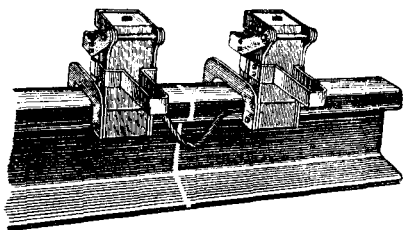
Стыковые соединители приварные (термитной сваркой) из стального троса
